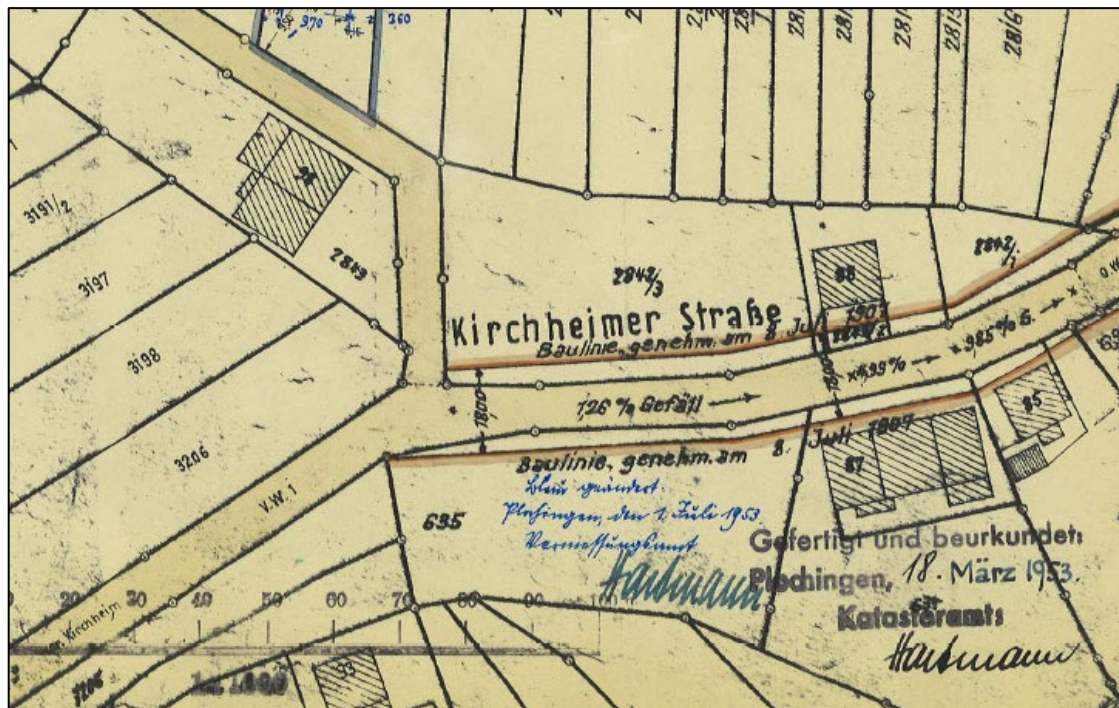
Baulinienplan der Gemeinde Hochdorf, Auszug aus einem Baugesuch aus dem Jahr 1953, genordet, ohne Maßstab
